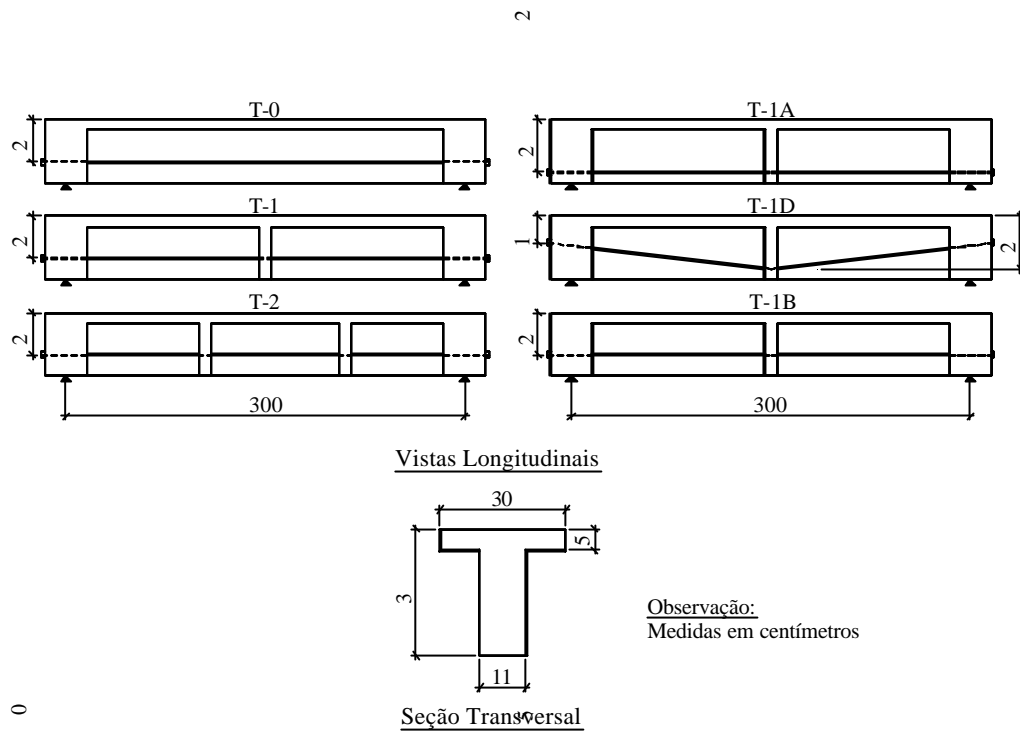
Vistas longitudinais e seção transversal das vigas ensaiadas por TAN & NG (1997)
